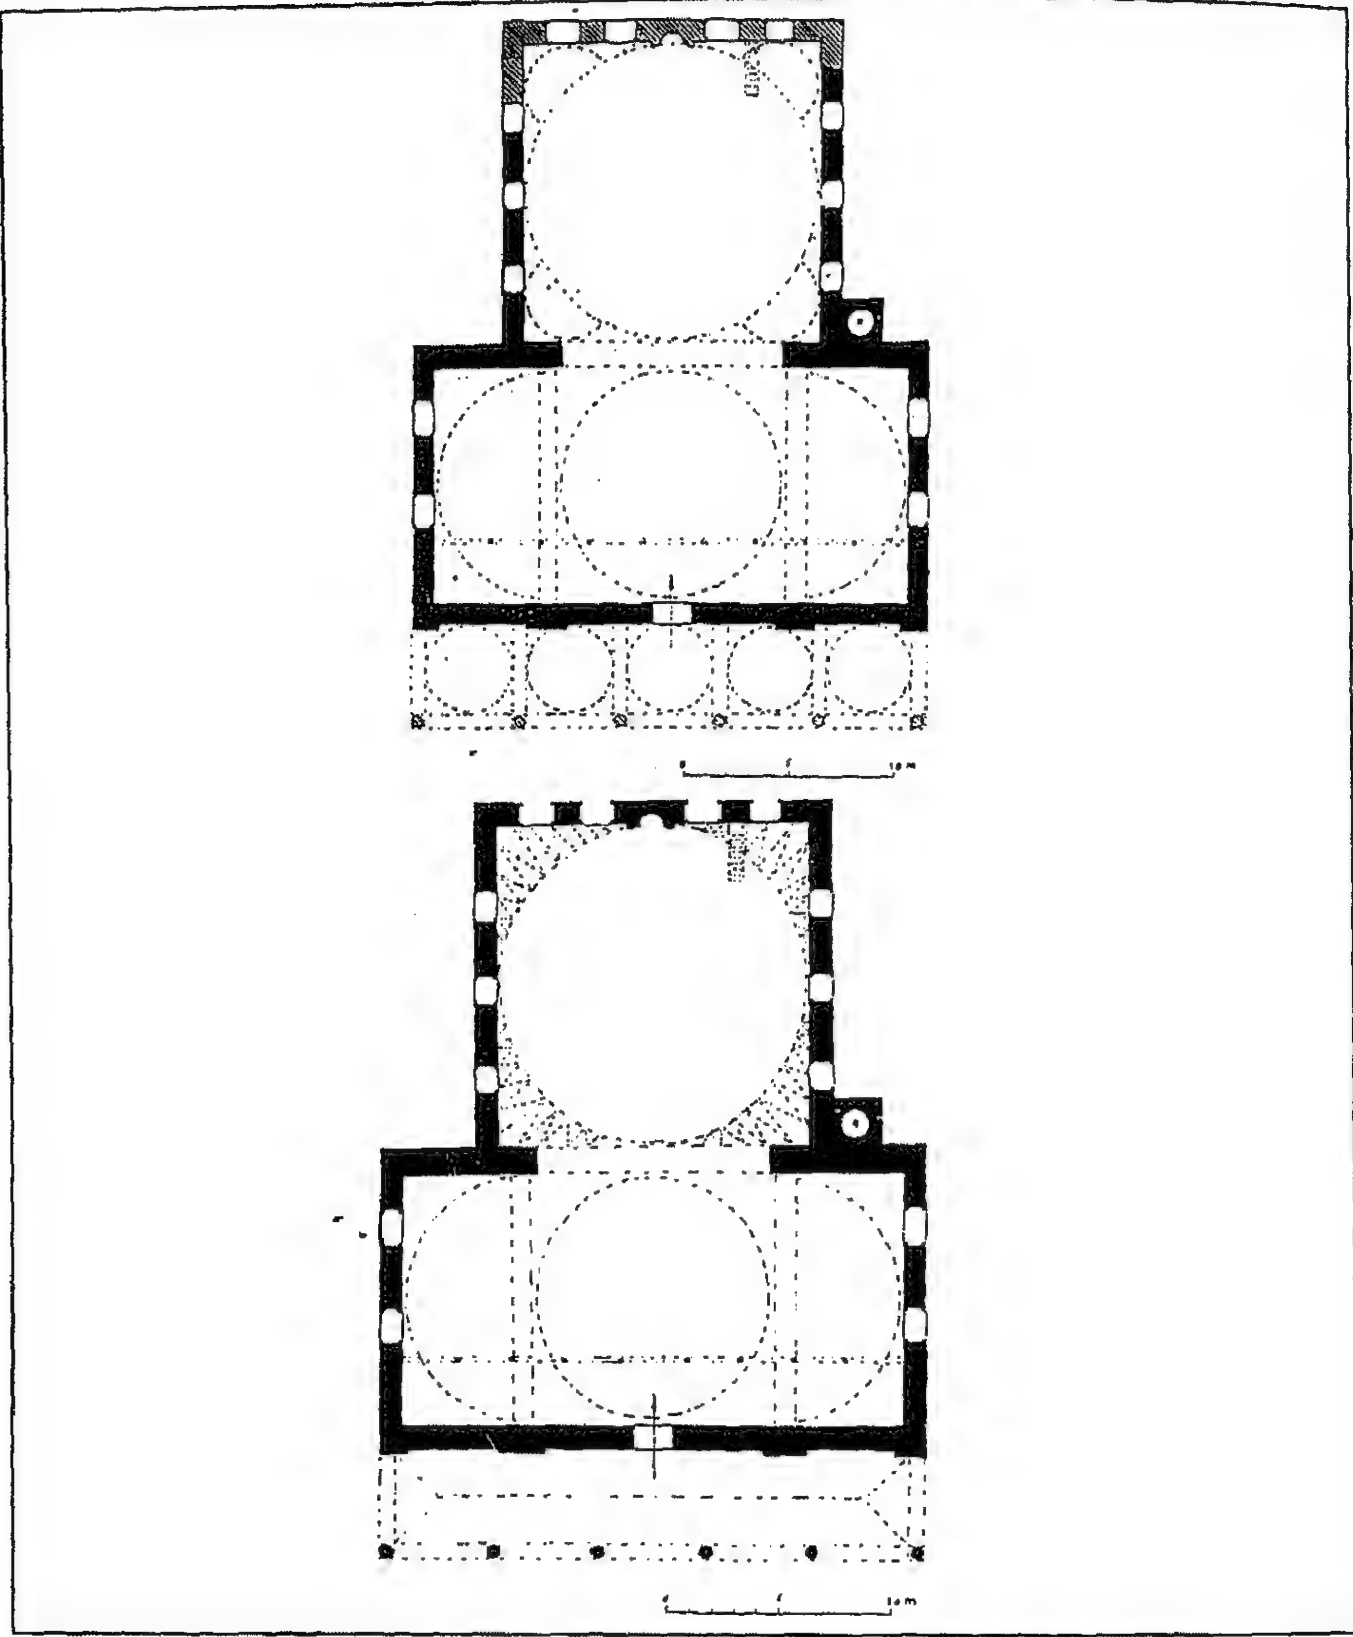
مسقط أفقي لمسجد كيل حسن أغا في روجوفو (عن : كيل) .
